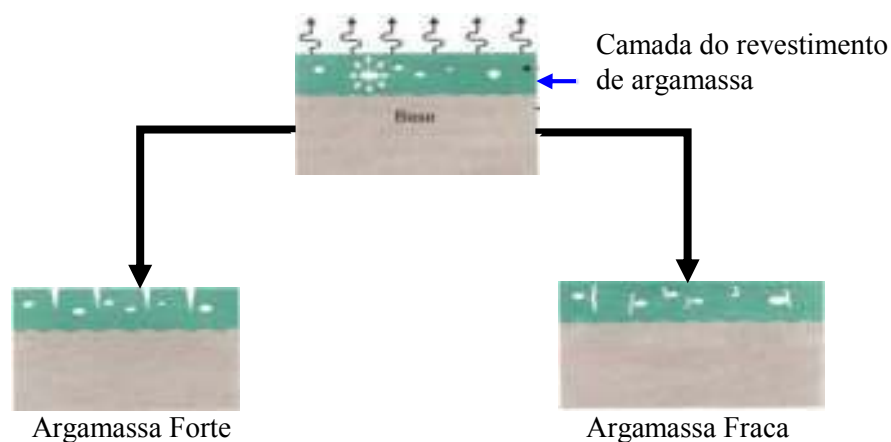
Estrutura das fissuras em argamassas fortes e fracas (SANTOS, 2008).
